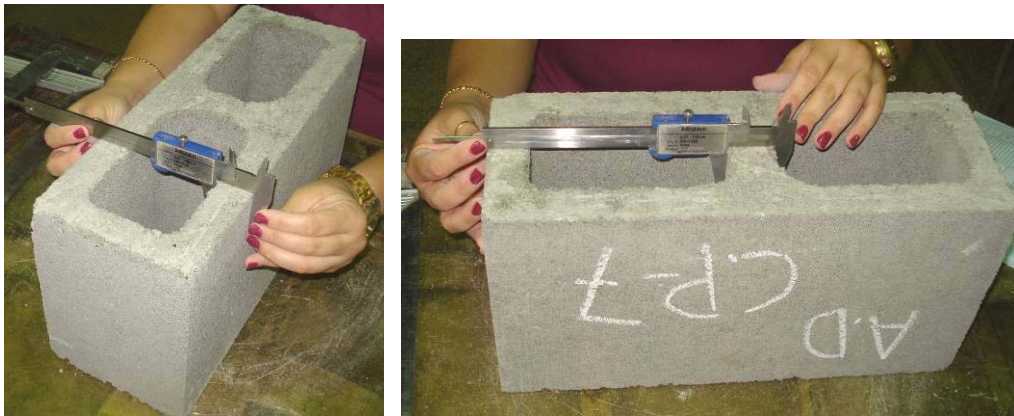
Medição da espessura das paredes longitudinais e transversais dos blocos
